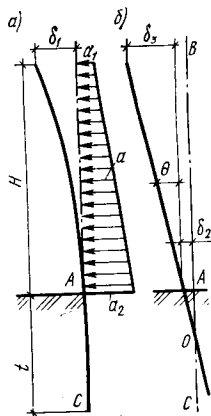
Схема к определению деформации шпунтовой стенки:
